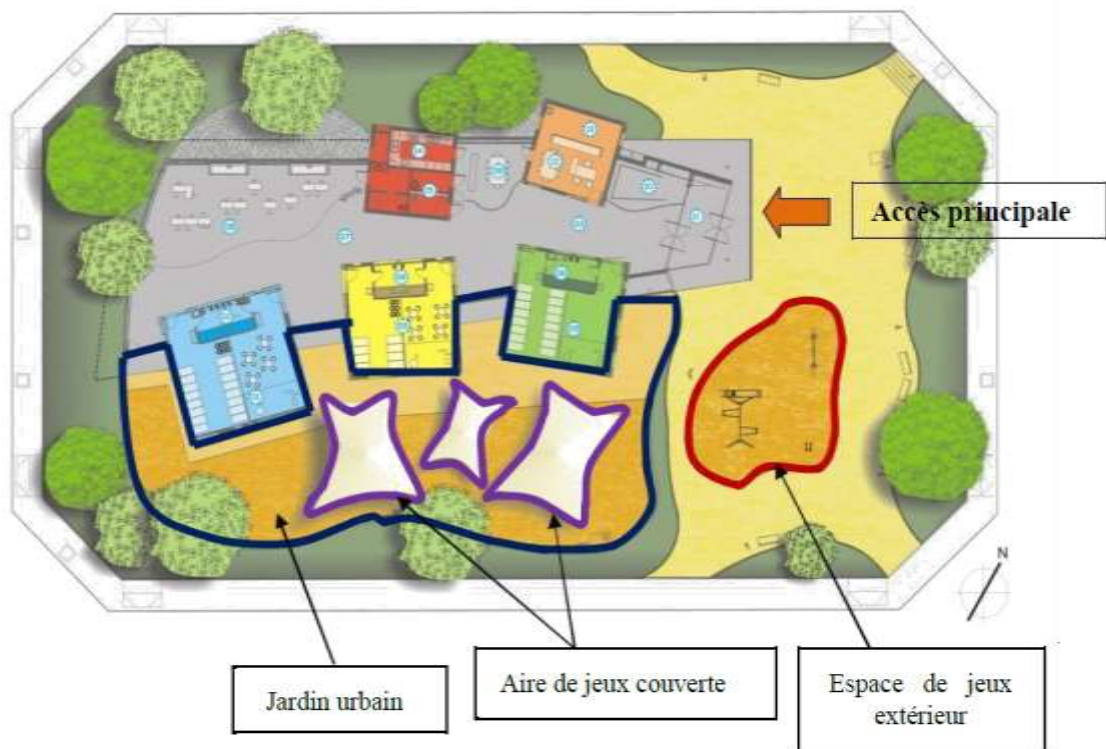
Plan RDC de 2ème exemple (Source : Aia.cat)
